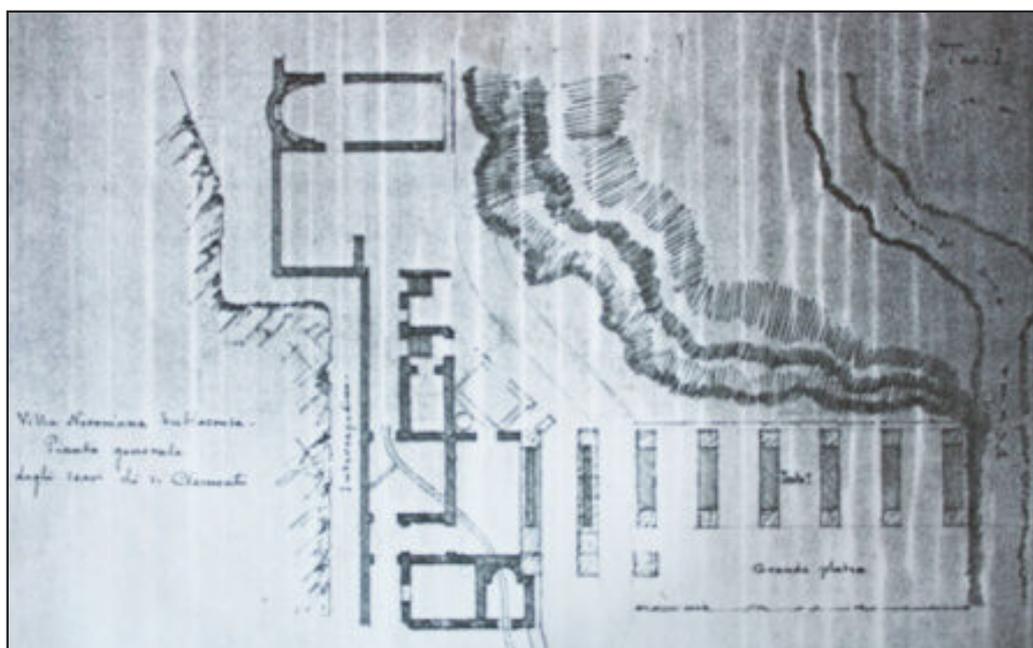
Planimetria generale dell'area di scavo in località S. Clemente (R. Lanciani, ACS, Ministero della Pubblica Istruzione. Direzione Generale Antichità e Belle Arti, Antichità e Scavi, 1° versamento. Subiaco, 1875 – 1891, busta n°149, fasc. 311).
